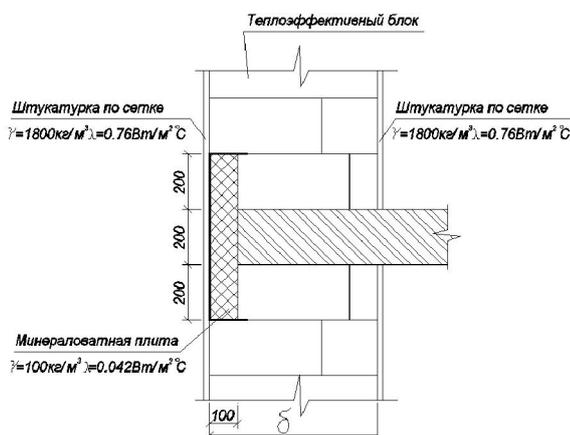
Схема конструктивного решения дополнительной теплоизоляции монолитного перекрытия
